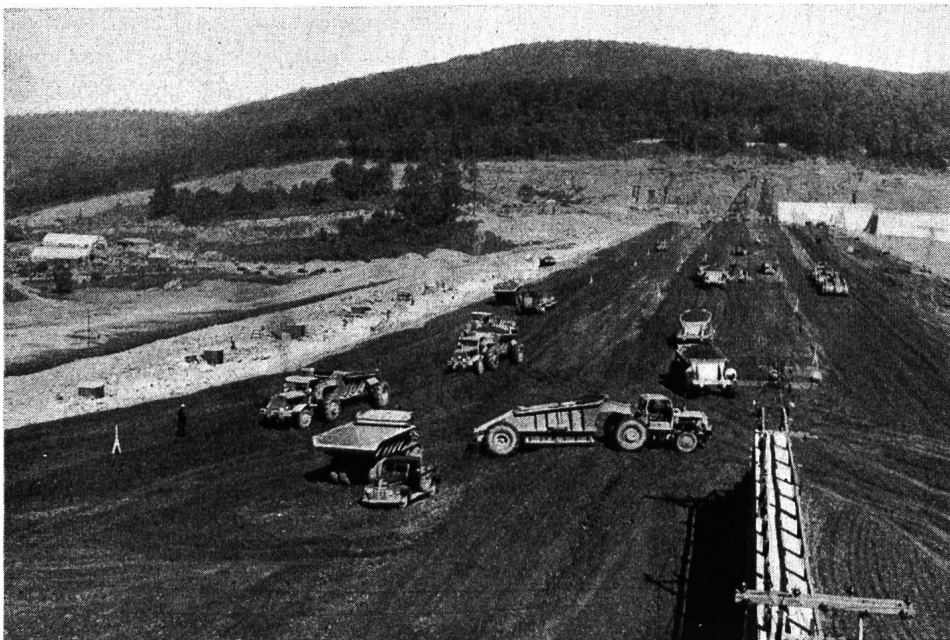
Downsville Dam, Aufnahme vom Dammbau
